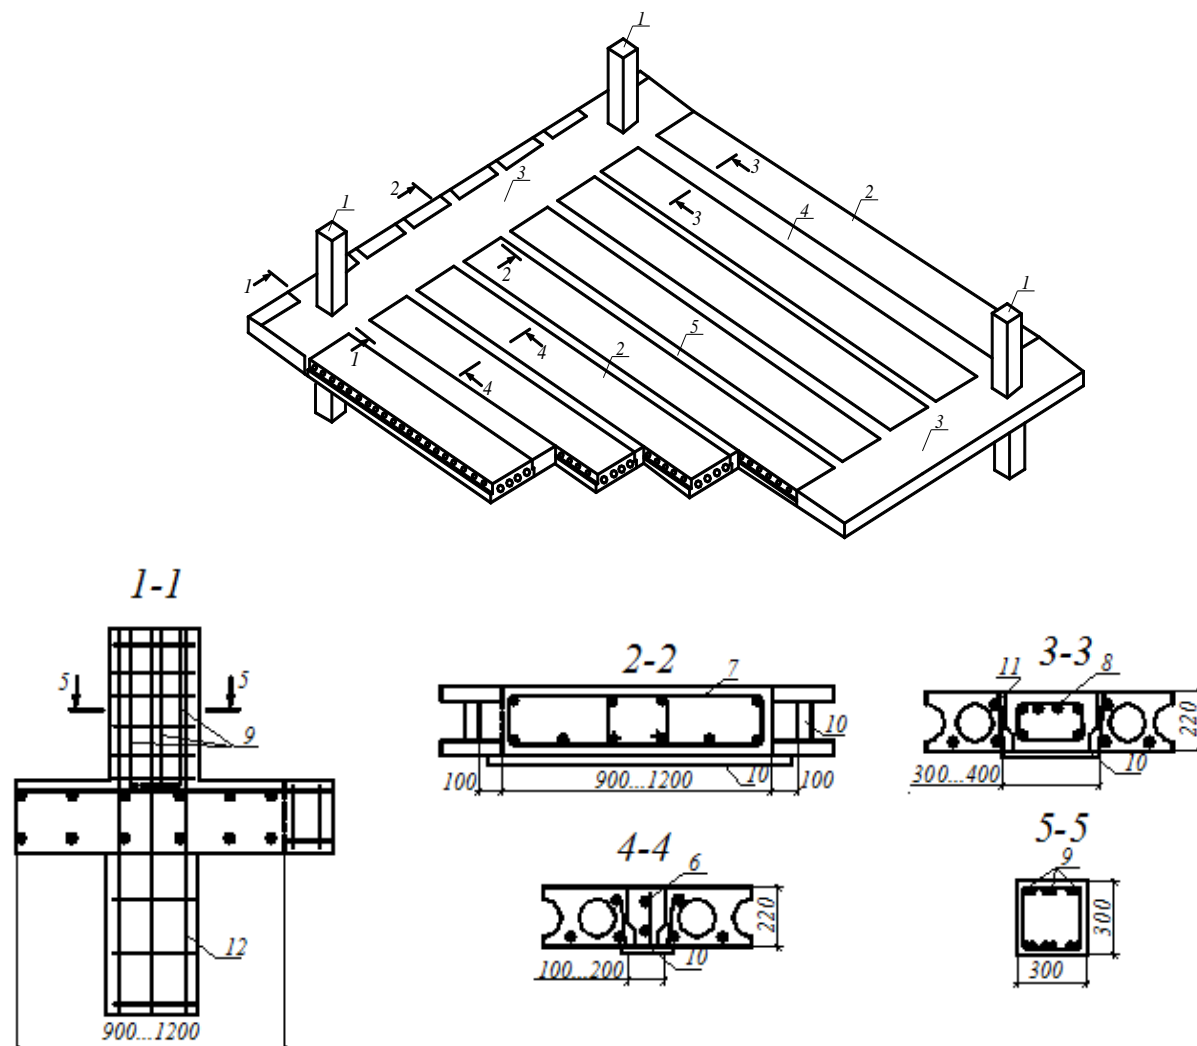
Збірно-монолітне перекриття типу «СОЧІ»: 1 – колони; 2 – збірні плити перекриття; 3 – монолітні ригелі; 4, 5 – монолітні балки між колонами та збірними плитами; 6 – 8 – арматурні каркаси монолітних елементів перекриття; 9 – стикові стрижні; 10 – опалубка; 11 – шпонка; 12 – арматурний каркас колон
